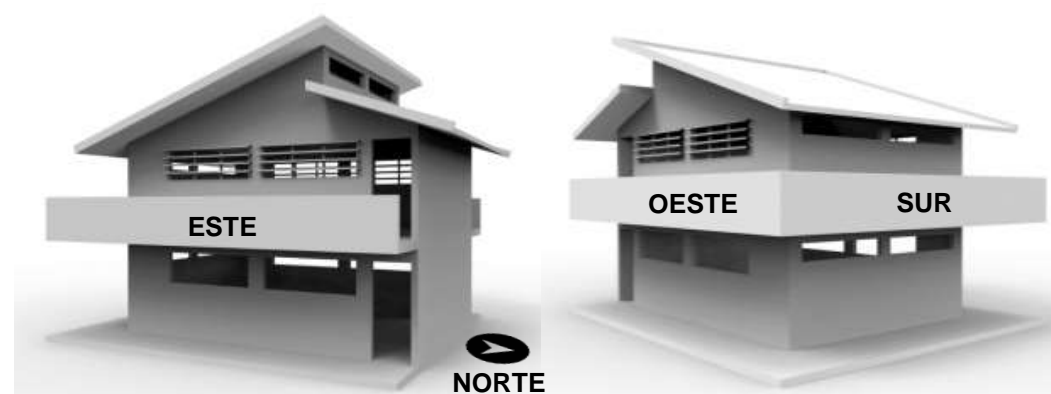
Edificio B, Fachadas noreste y suroeste. Fuente: Elaboración propia.
